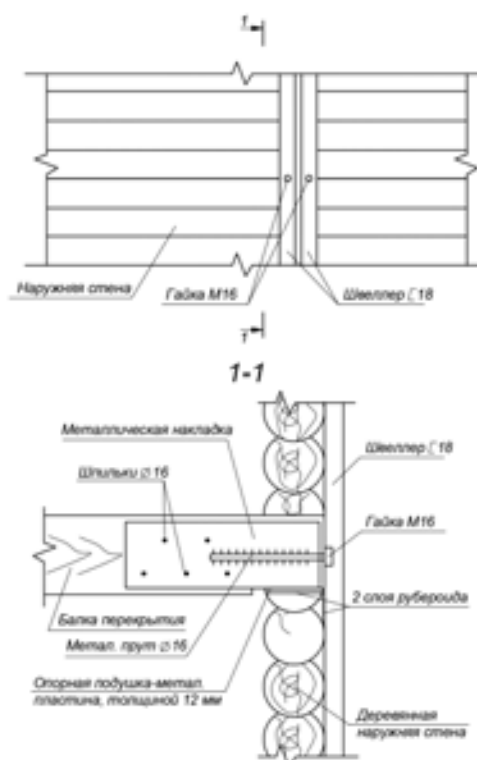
Узлы сопряжения балки перекрытия с наружной стеной
